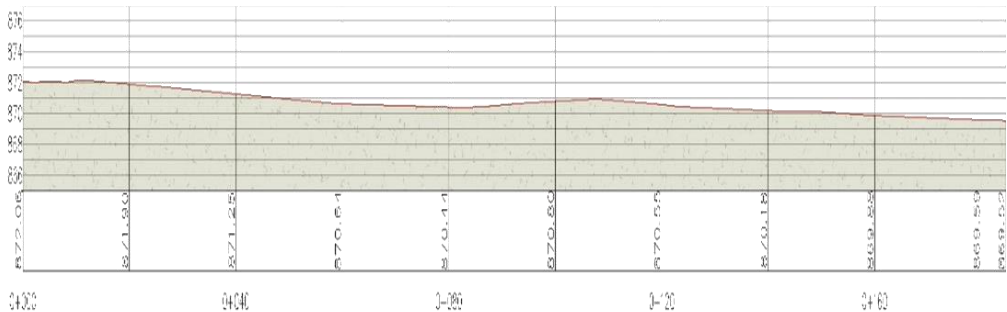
Corte A-A perfil longitudinal. Elaboración propia.
